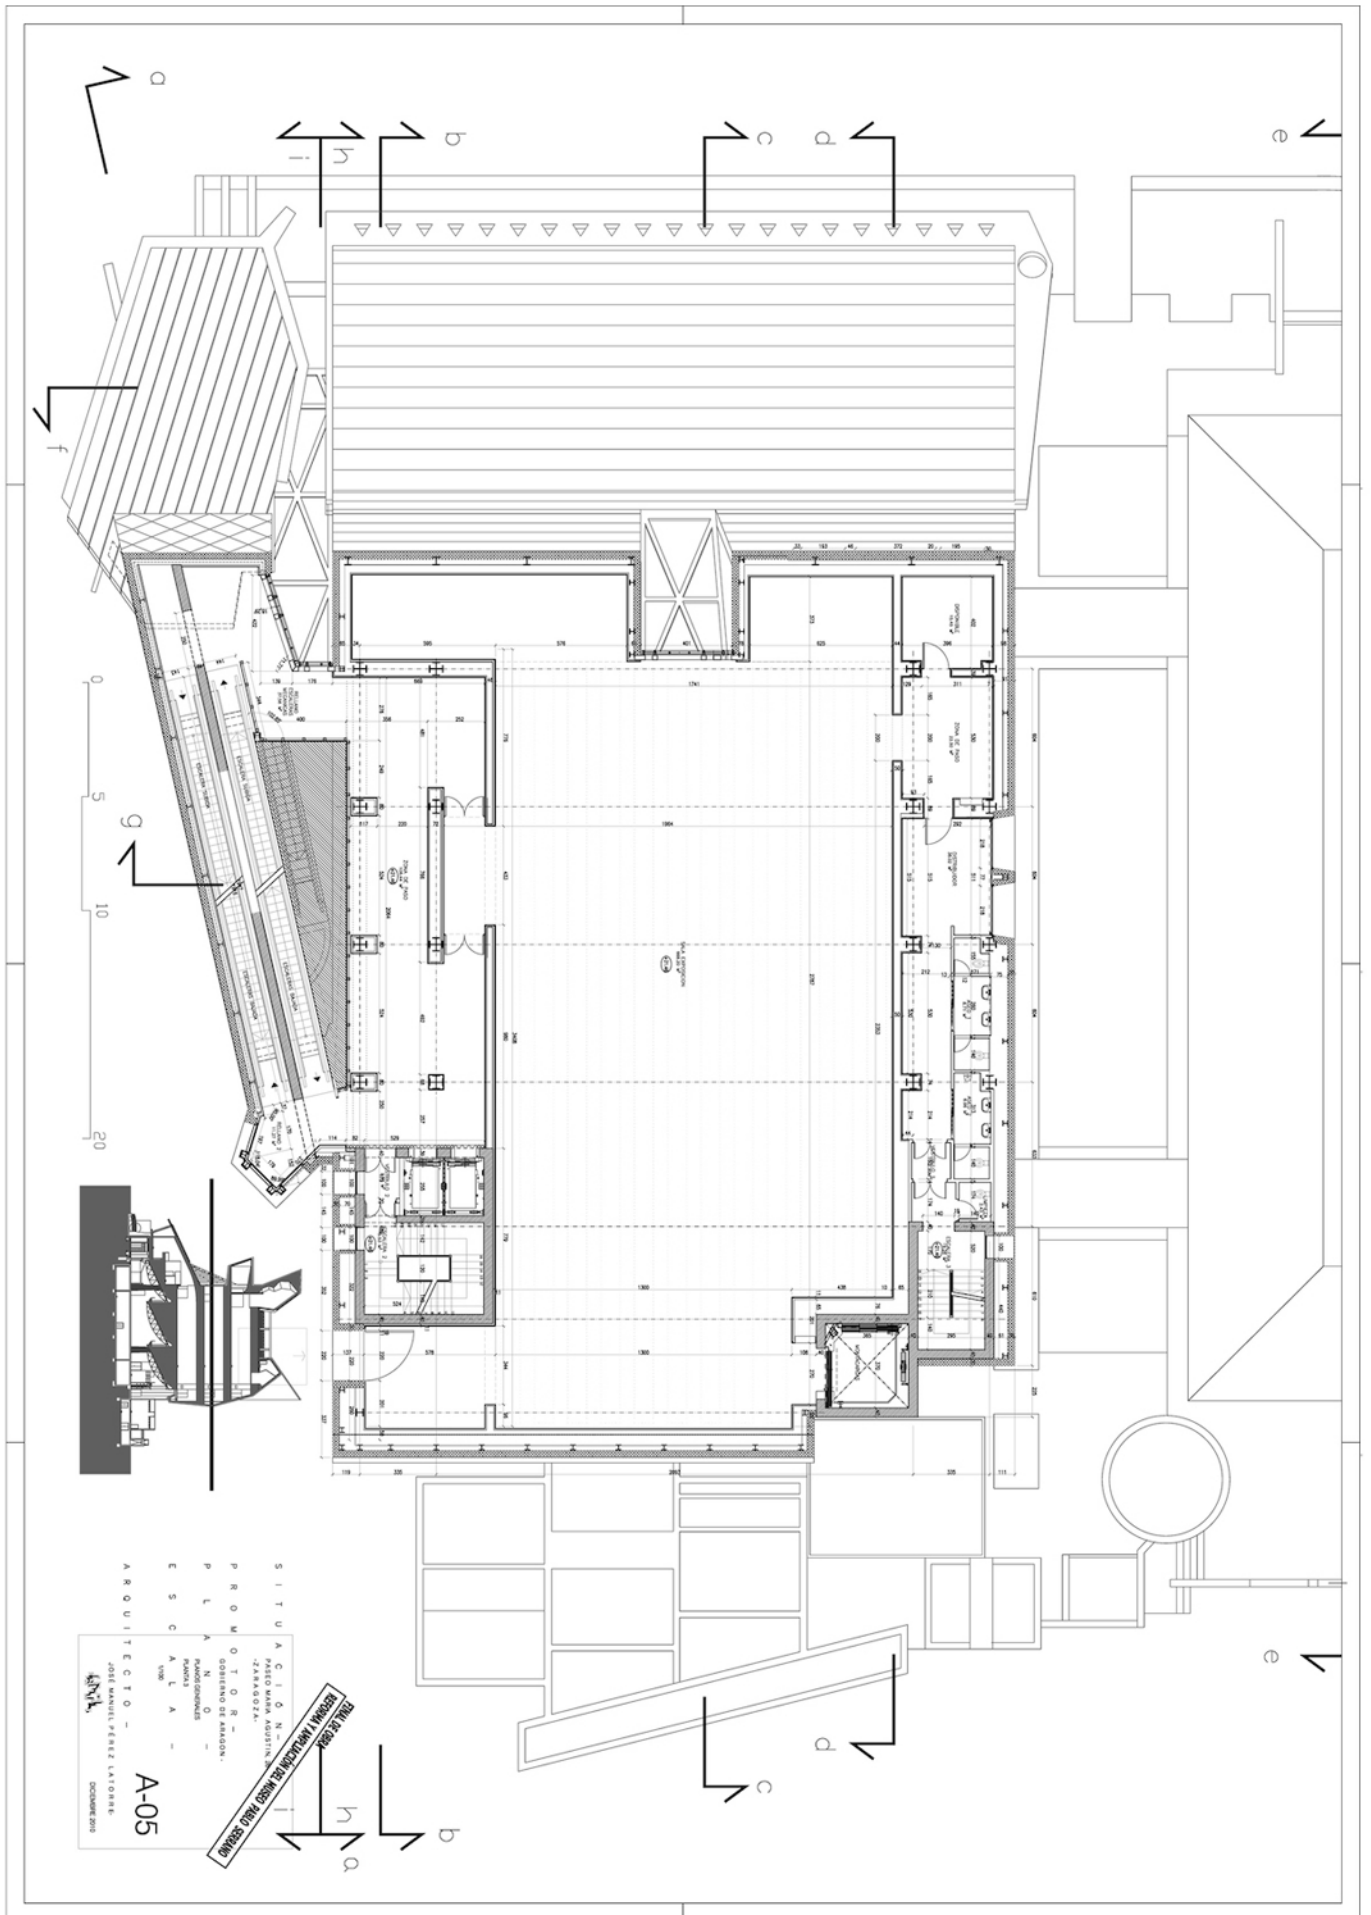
Planta tercera (según J.M. Pérez Latorre)
